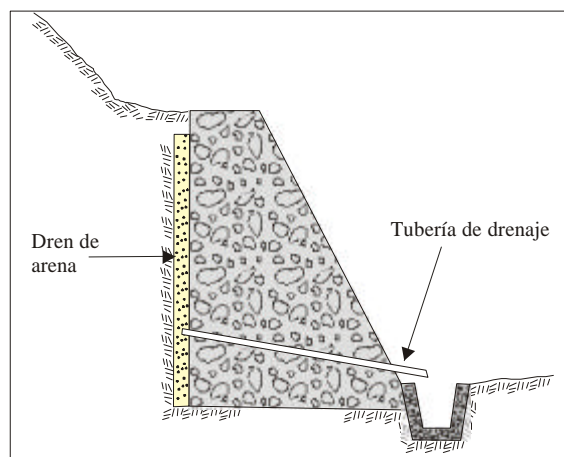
Muro de gravedad de concreto ciclópeo
